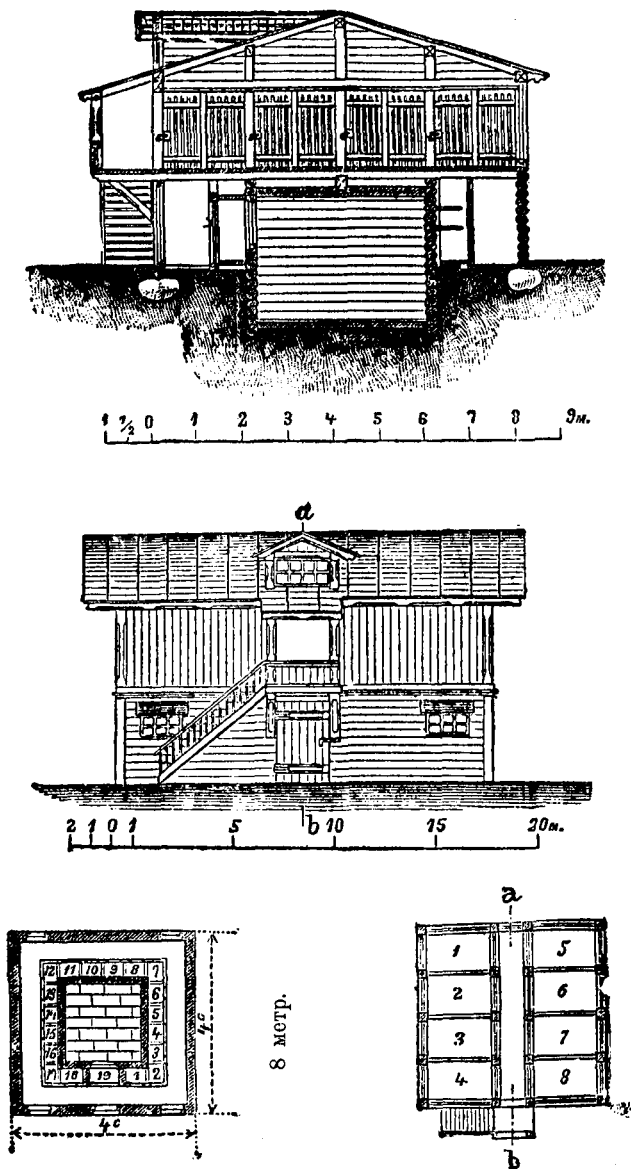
23. Войсковой ледникъ. Вверху—разръзъ по а б; въ среднѣй — фасадъ; внизу слѣва — планъ 1-го этажа; справа планъ 2-го этажа.
